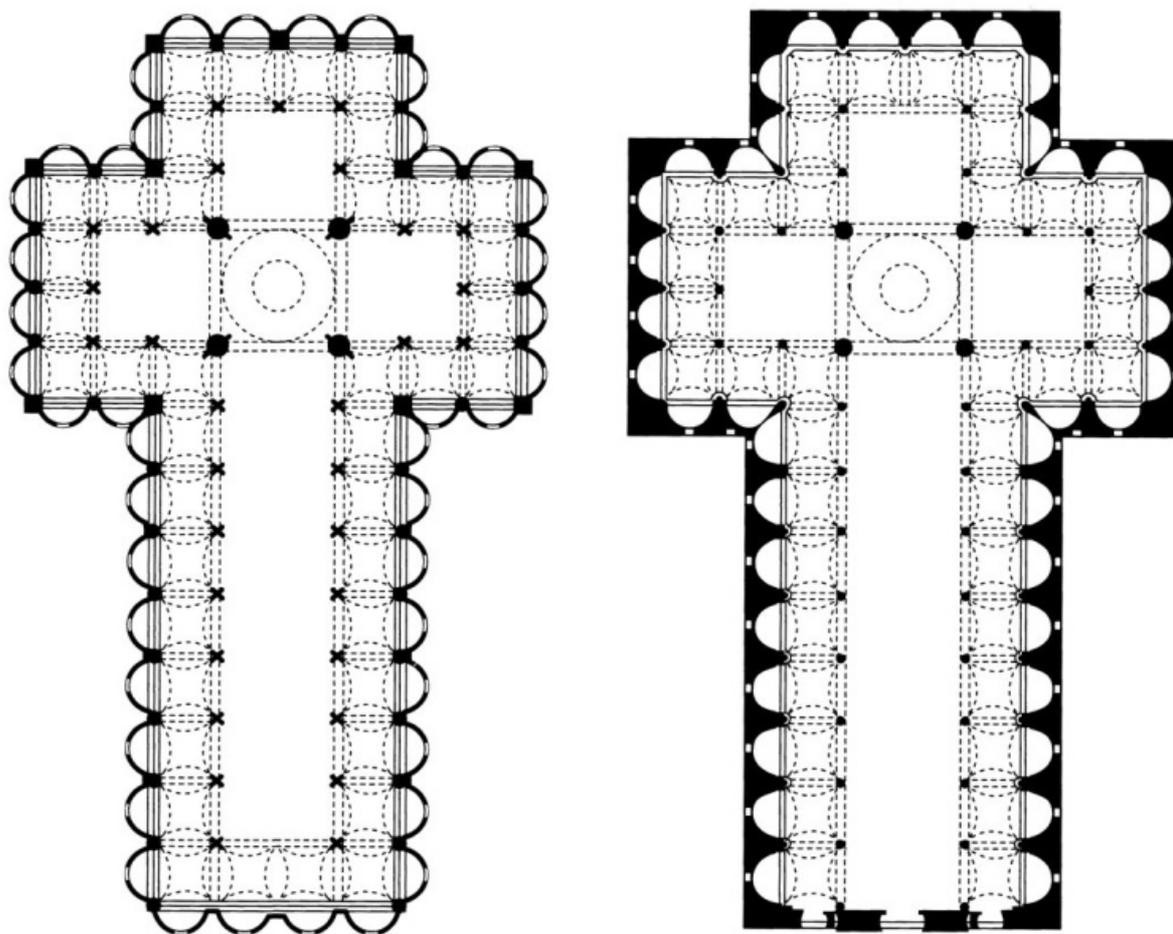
Plano del proyecto de Brunelleschi y plano del proyecto final, Santo Spirito.
